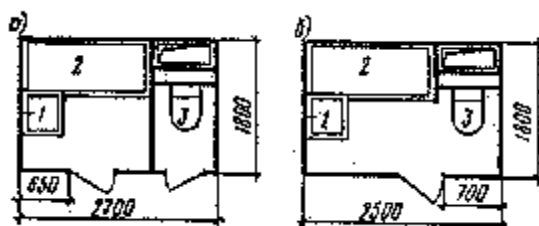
Типы санитарных узлов квартиры: а – раздельный; б – совмещенный; 1 – умывальник, 2 – ванна, 3 – унитаз.
